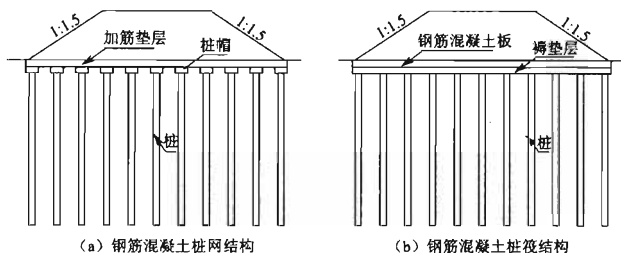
钢筋混凝土桩网结构与桩筏结构
